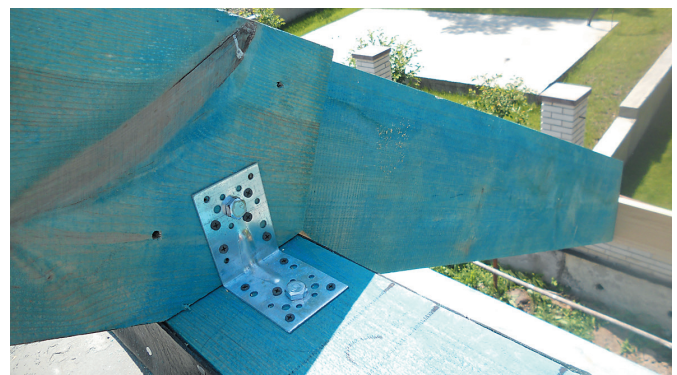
Установка кобылки внутри составной стропильной ноги сечением 250x40 мм при глубине карнизного свеса 1200 мм
